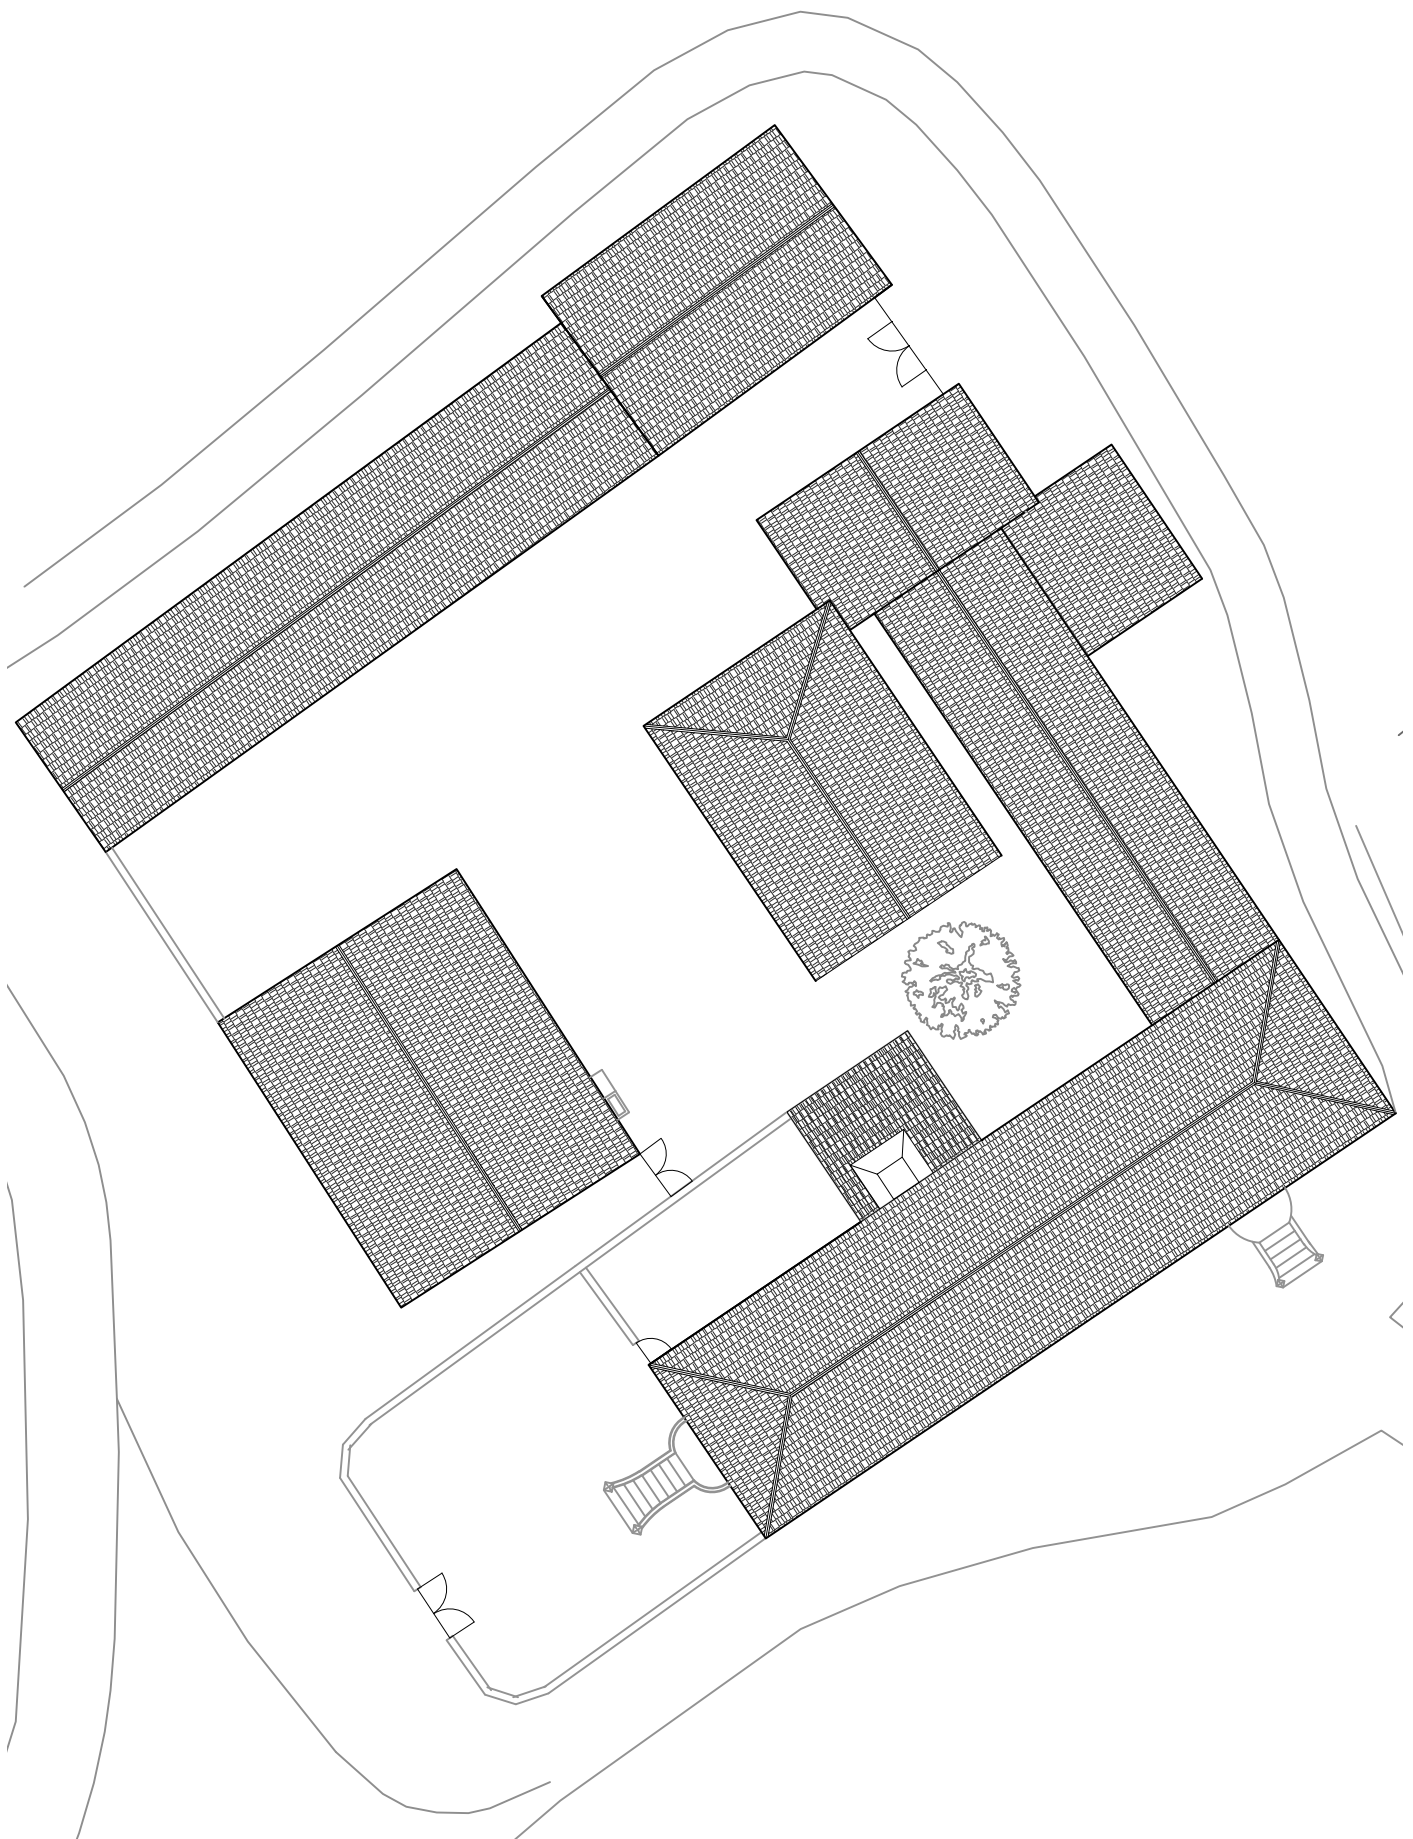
Piso 1 - Planta de Cobertura do Conjunto Arquitetônico
